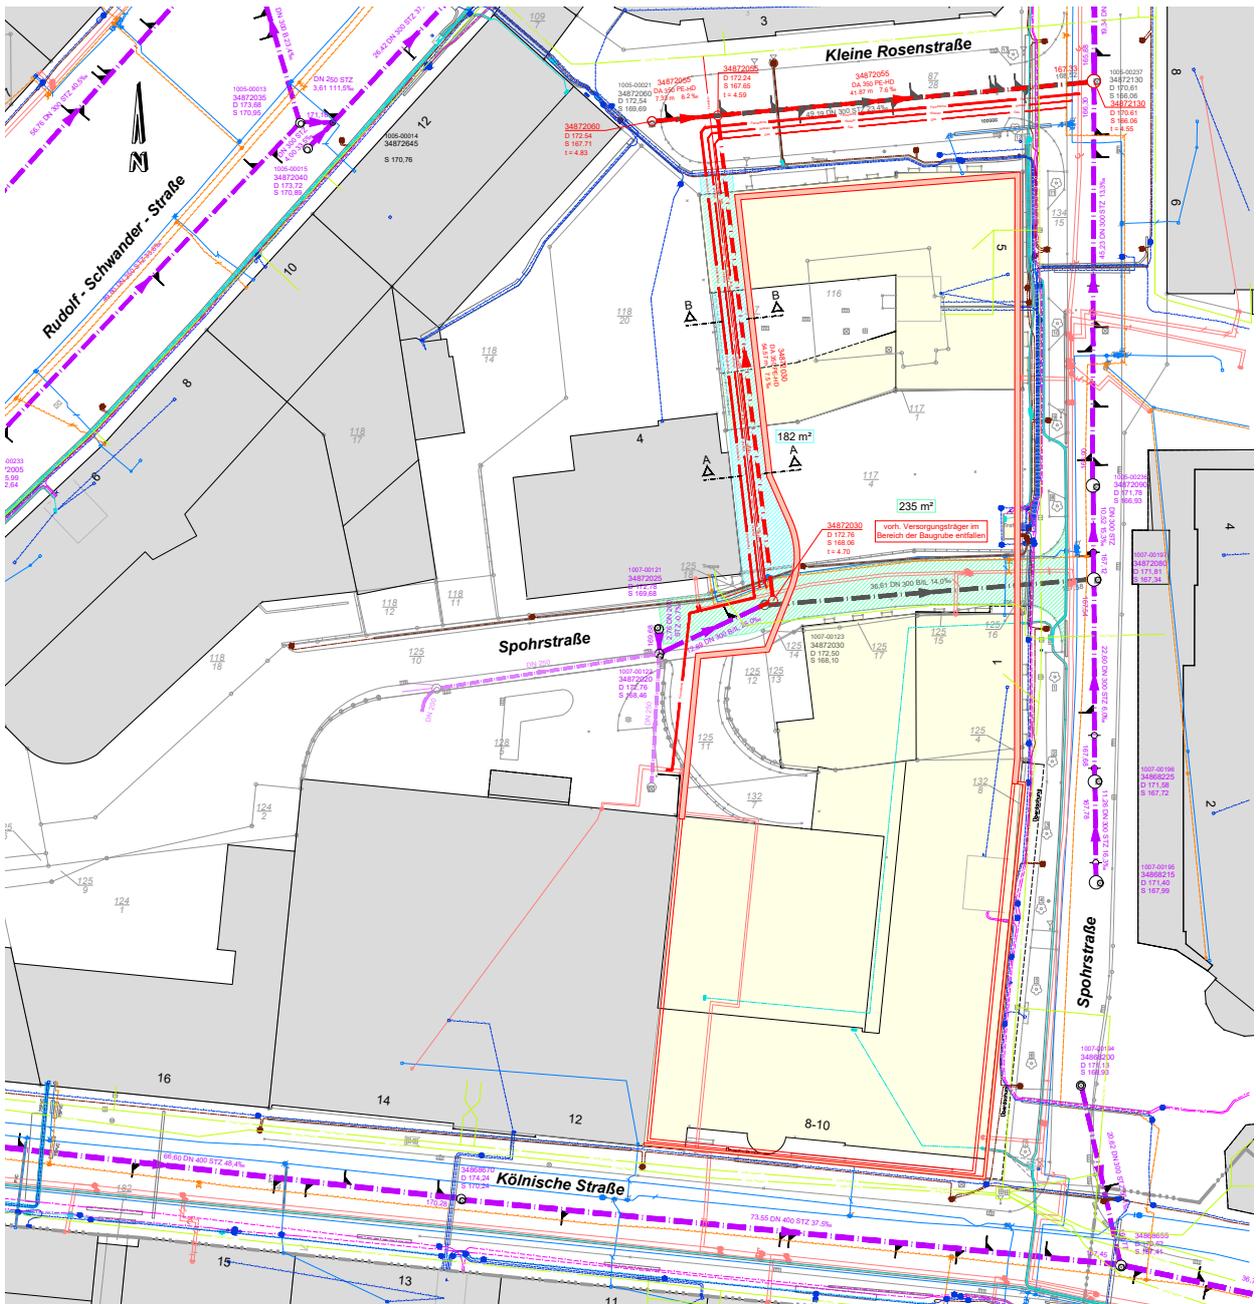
Leitungsbestand und geplante Verlegung vorhandener Leitungen (rot) in einer Leitungs-Trasse über Kleine Rosenstraße und nördliches Vorhabengrundstück in die Stichstraße, Quelle: Ingenieurbüro Oppermann, Vellmar
